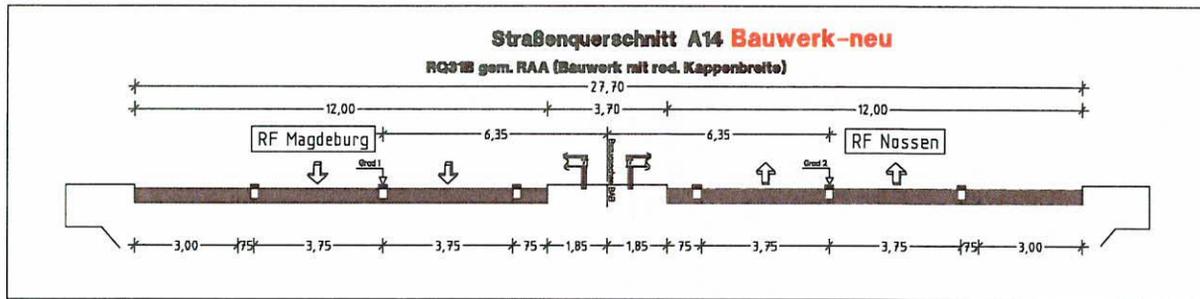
geplanter Straßenquerschnitt RQ 31B im Bauwerksbereich
